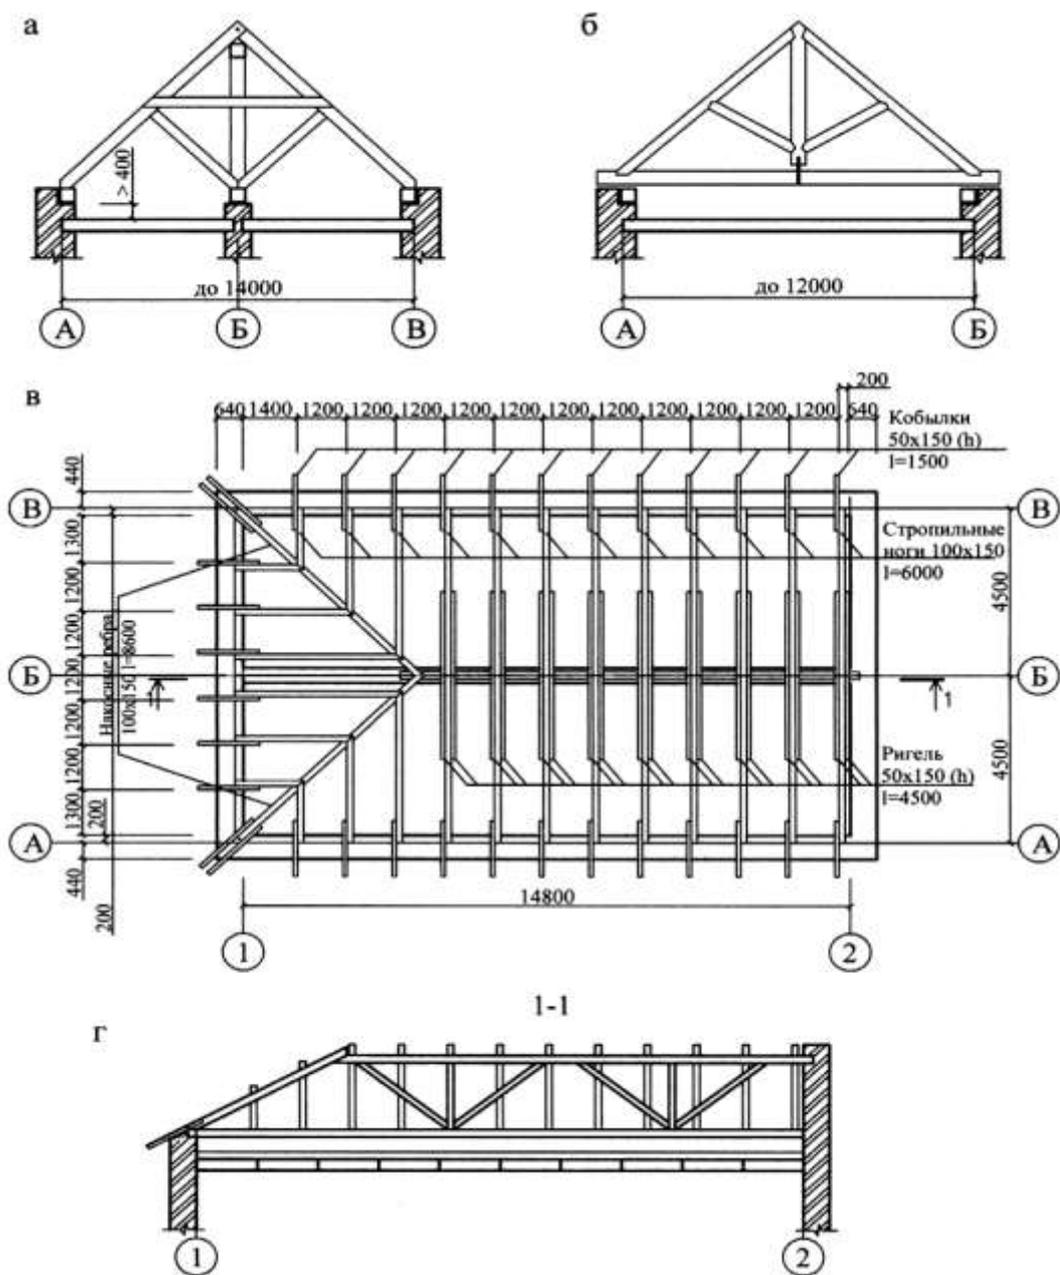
Стропильные конструкции малоэтажных зданий:
